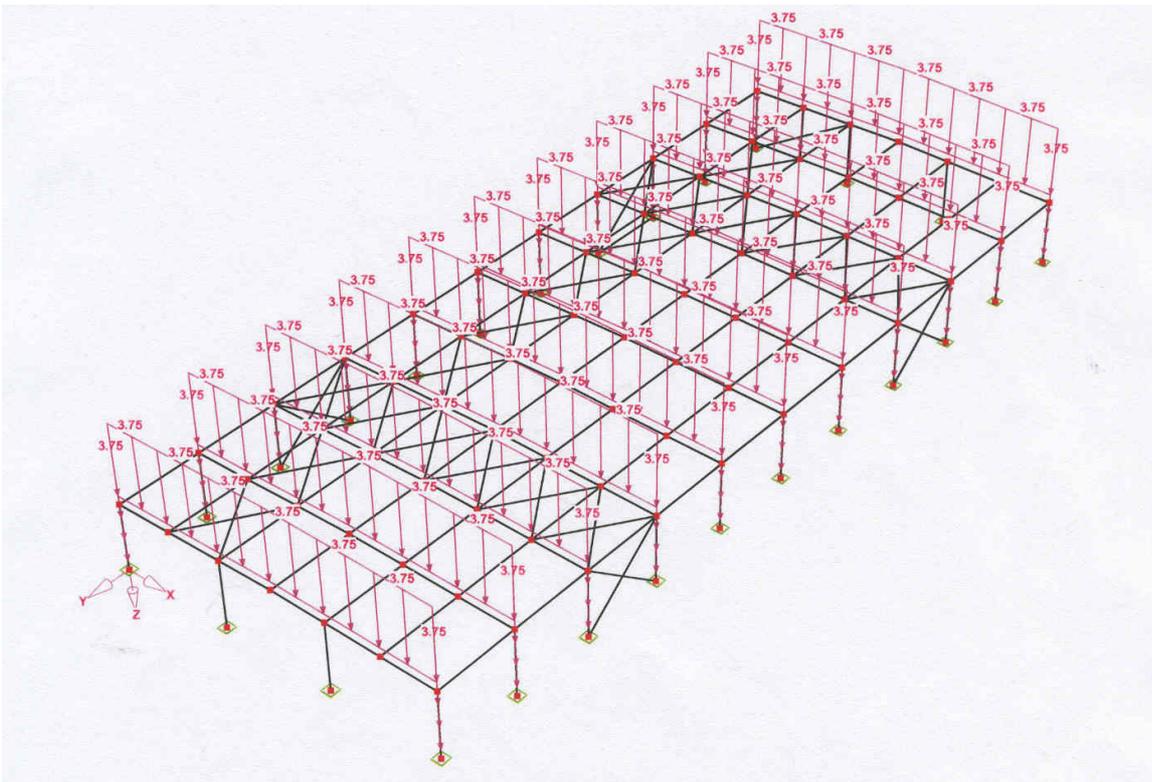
Lastfall ständige Lasten Dachaufbau
